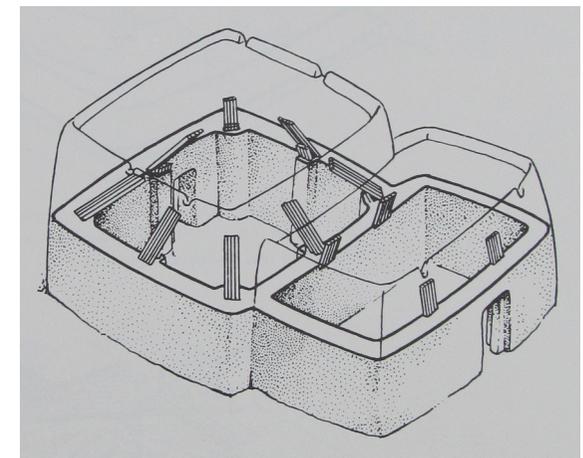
Axonometrie Flachdachkonstruktionsdetail mit Konstruktionsschichten
